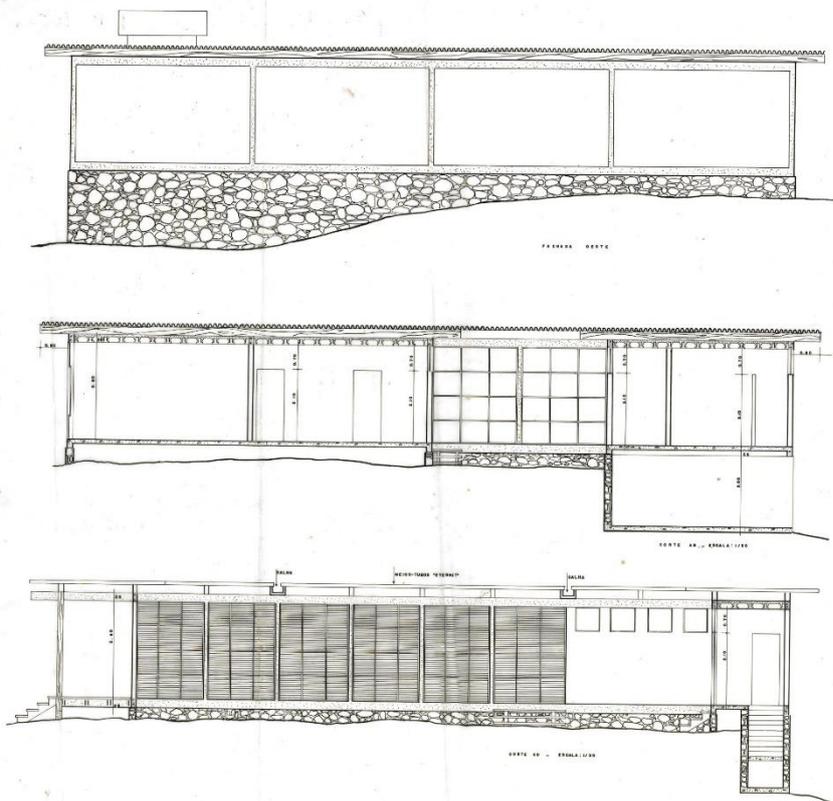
Fachada Oeste (posterior), Corte AB, Corte CD.
